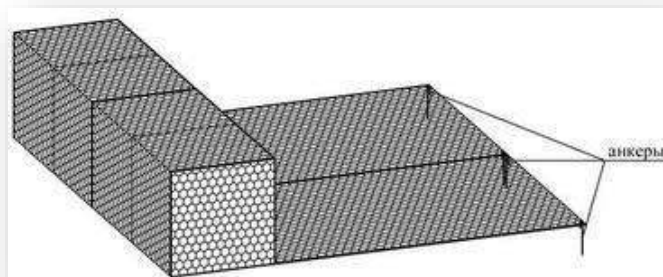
Установка крышки коробчатых габионных конструкций с армопанелью
